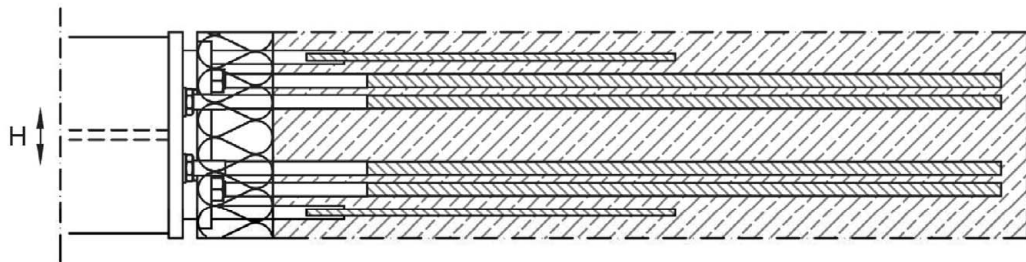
Grundriss IP 80 SM14 QQ
